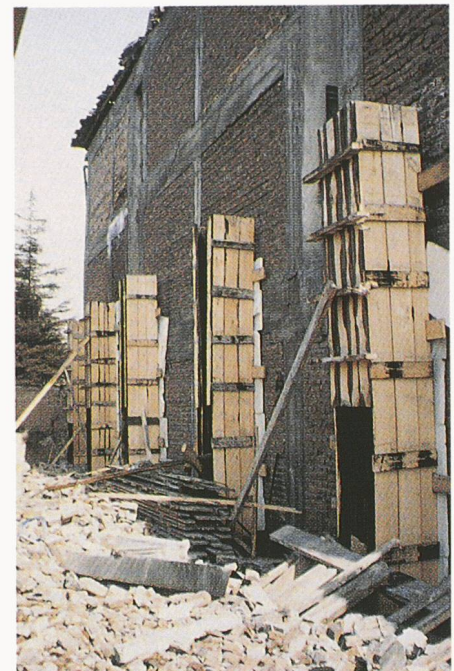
Dreigeschossiger Stahlbetonskelettneubau, mit Modul-Backsteinen ausgefacht, ohne Schäden in der Tragstruktur
